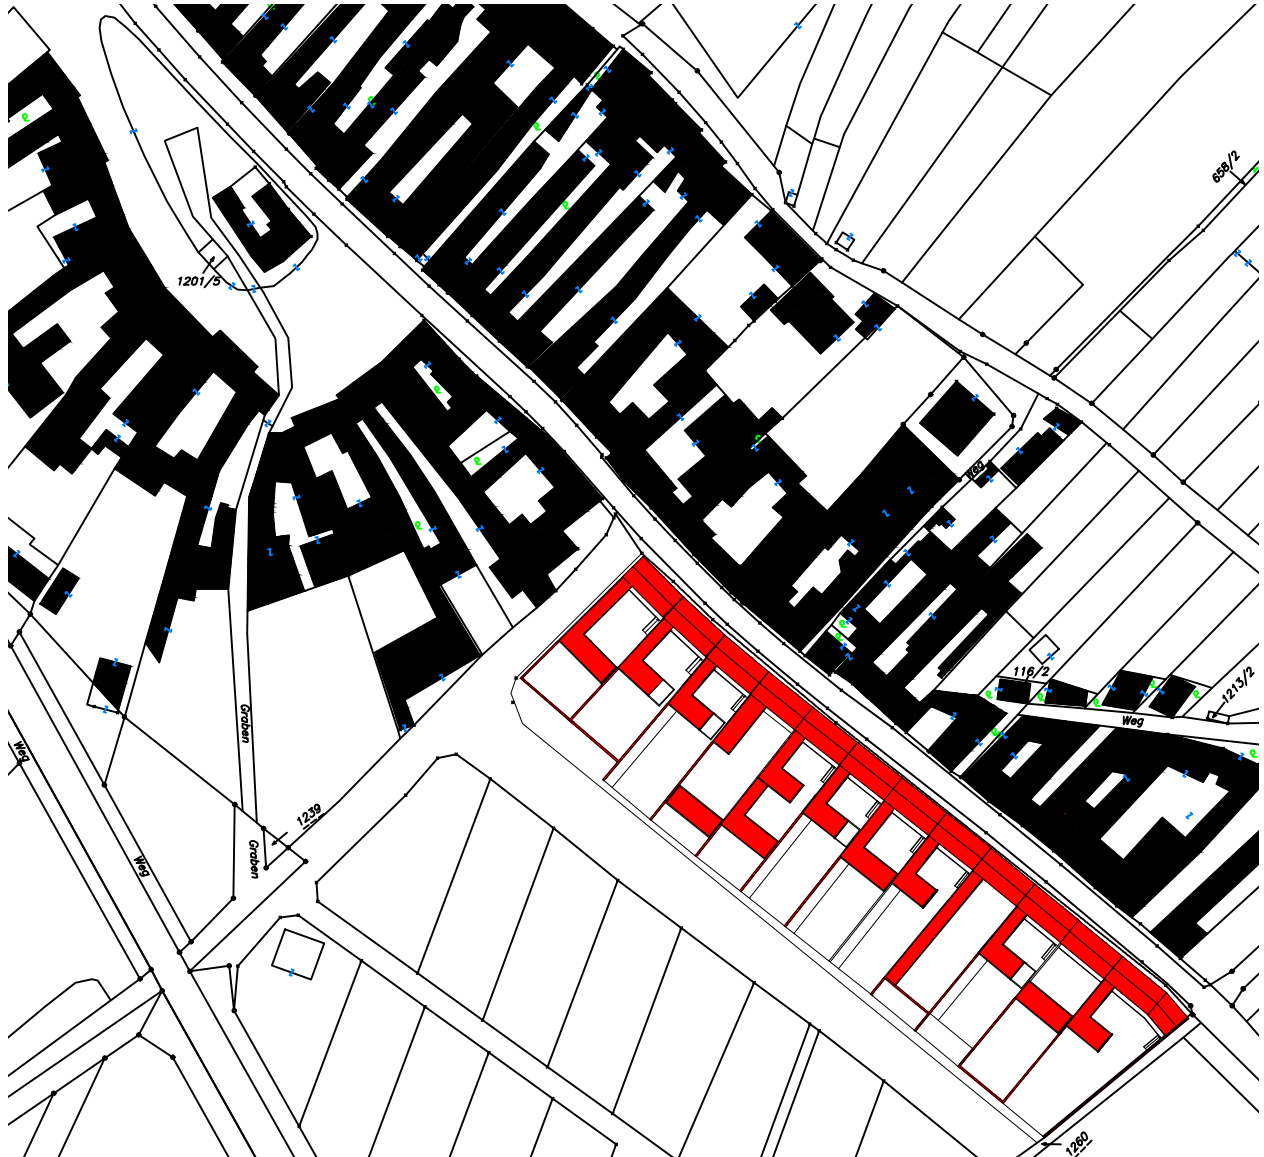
Lageplan M 1 : 2000. Alte Dorfstruktur und neue Gartenhofsiedlung entlang der Hauptstrasse.
